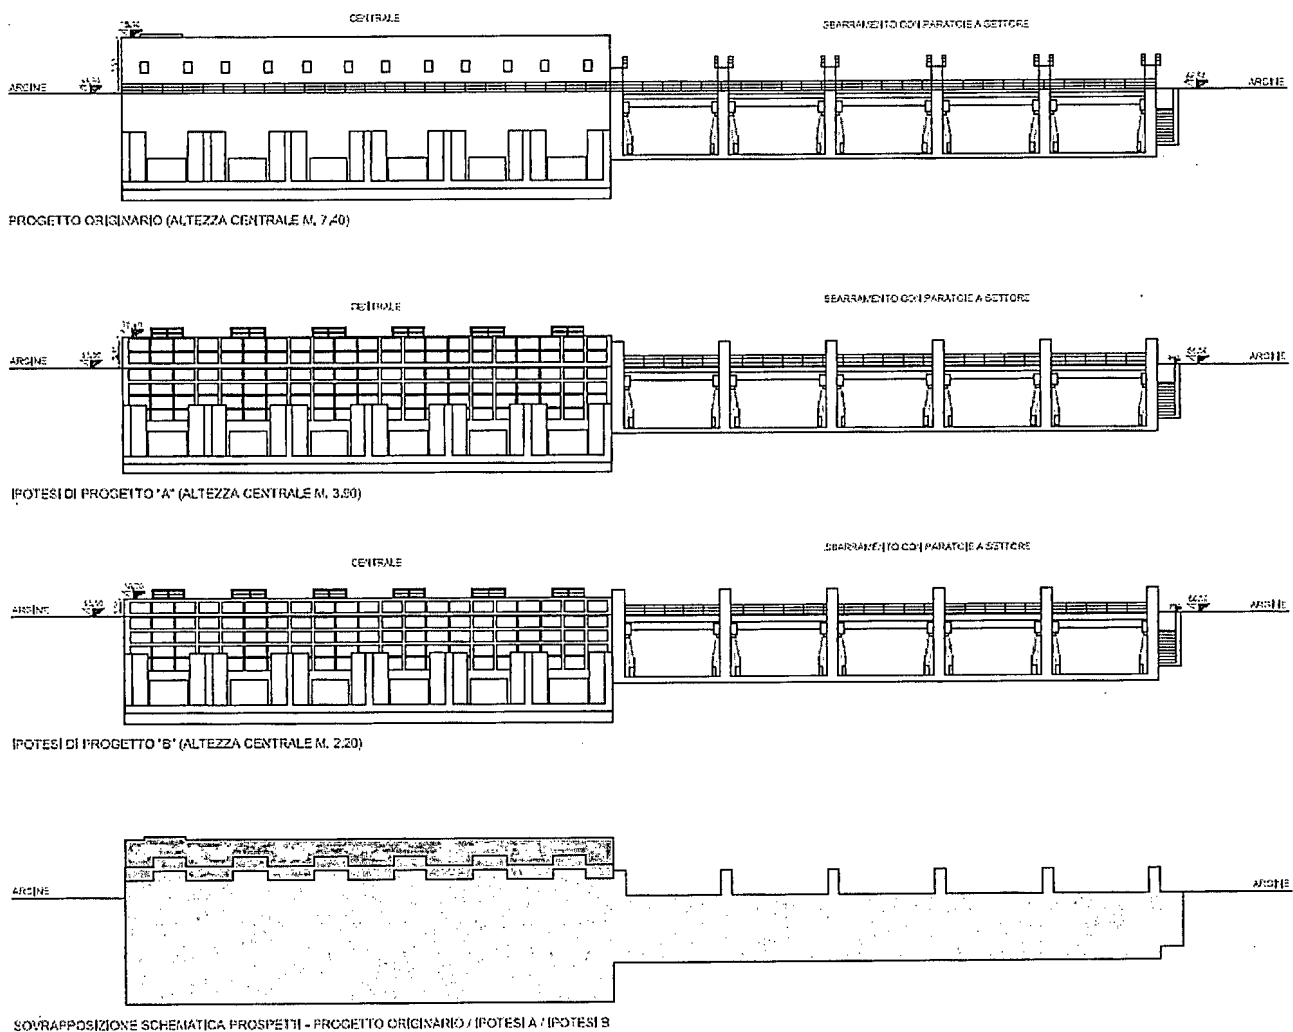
Prospetti della centrale idroelettrica nelle diverse ipotesi di progetto e loro sovrapposizione schematica
